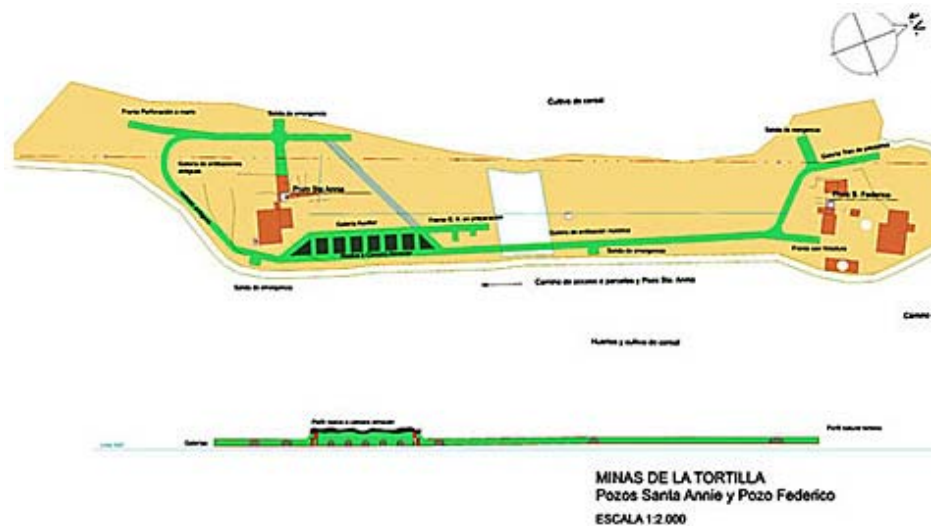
Plano del proyecto de mina visitable, en La Tortilla.
